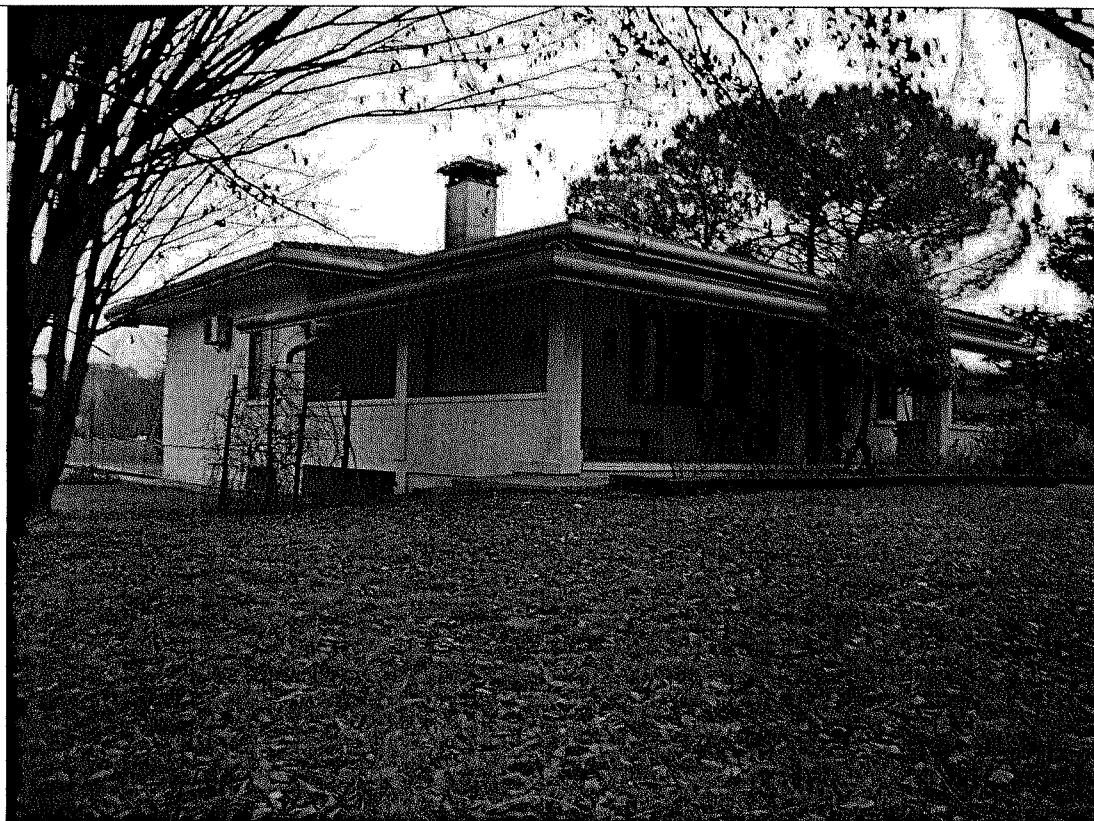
vista del prospetto nord-est dell'abitazione
